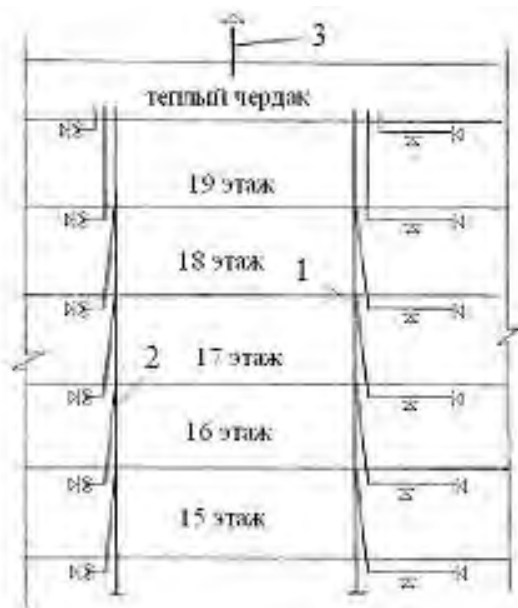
Принципиальная схема вытяжных вентиляционных систем квартир верхних этажей здания
